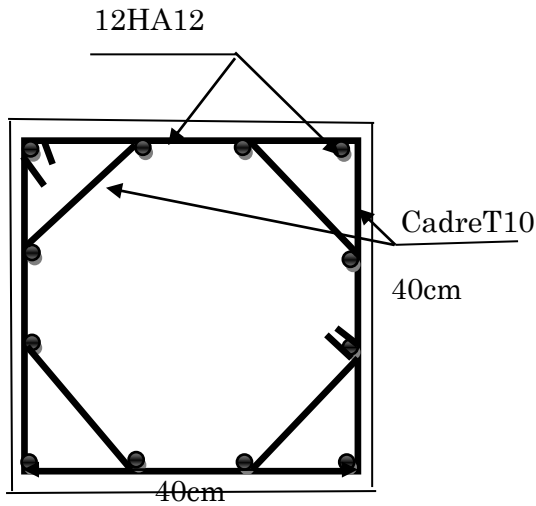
Schéma de ferrailage des Poteaux 2^{ème} et 3^{ème} étages
